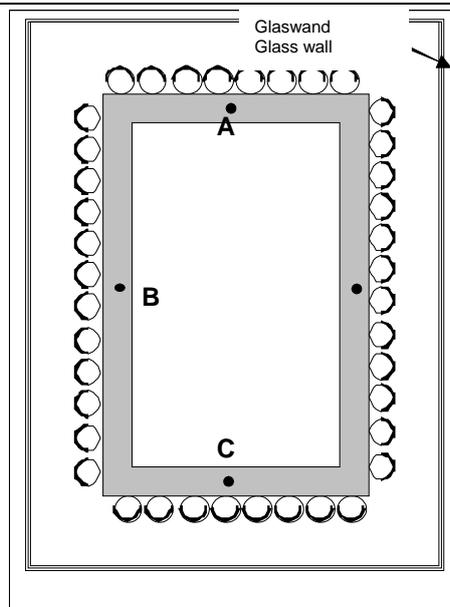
Grundriss des Sitzungsraumes 1
